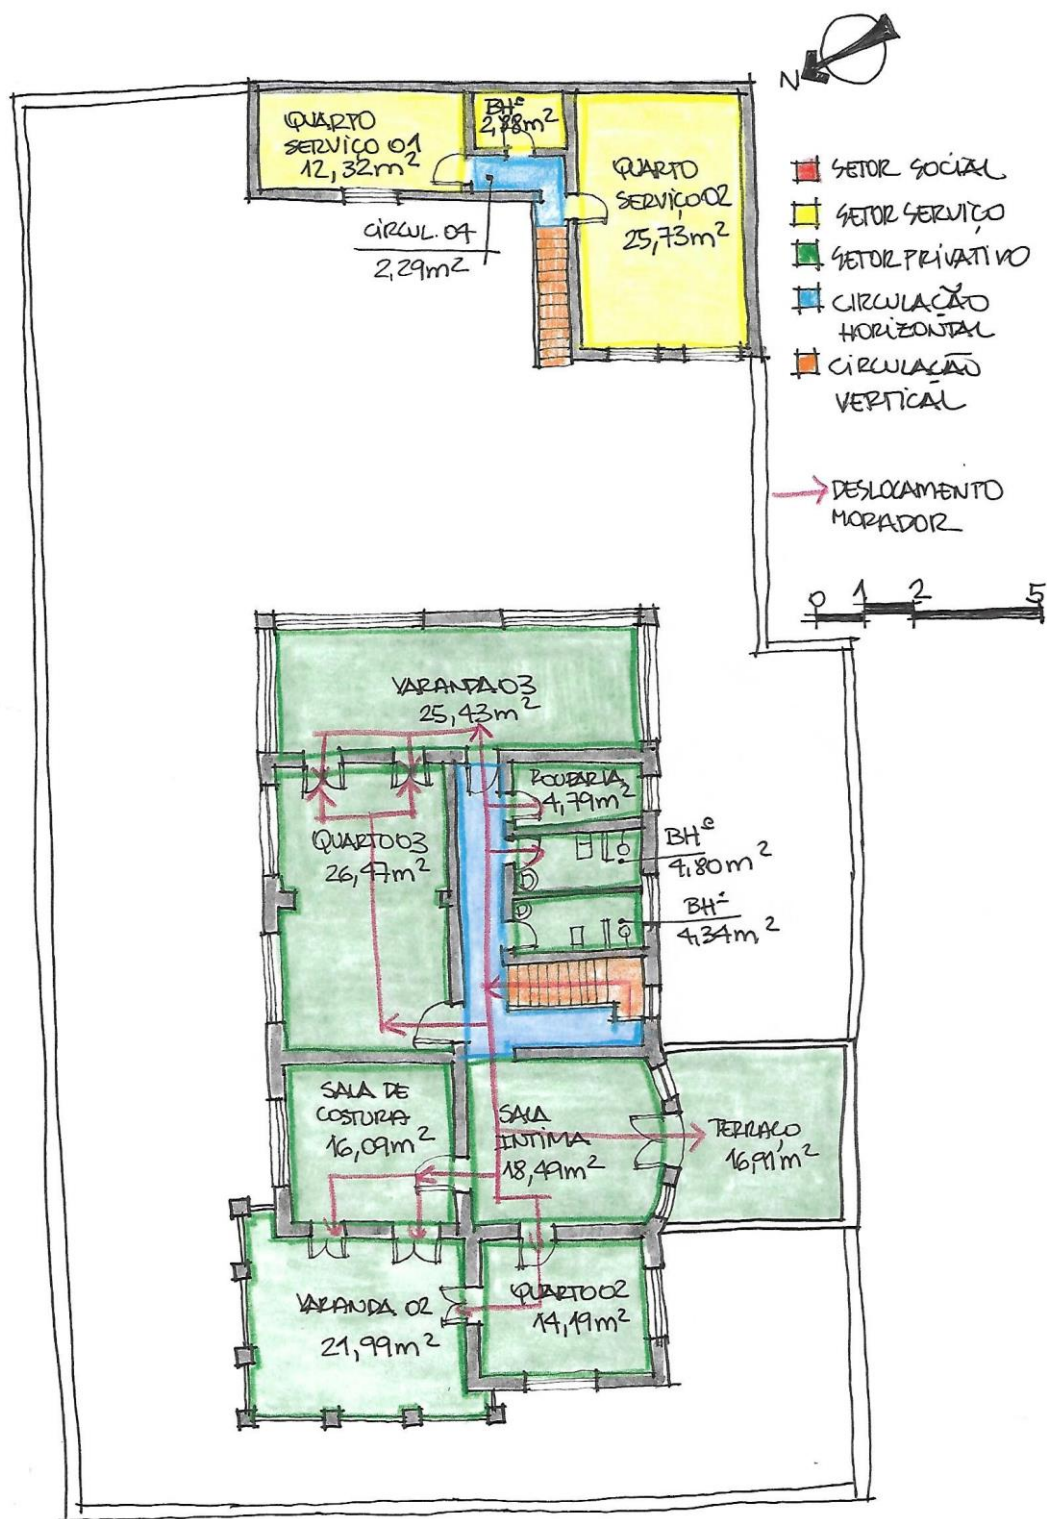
Planta do pavimento superior da Residência Nº 139. Fonte: autora, 2019.
